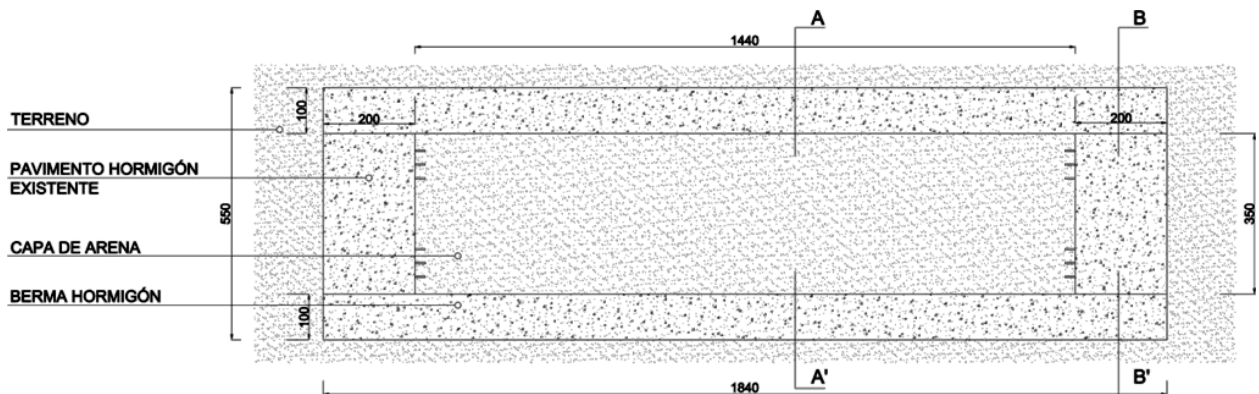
Vista en planta de la construcción en terreno que acogió al sistema de losas prefabricadas.
